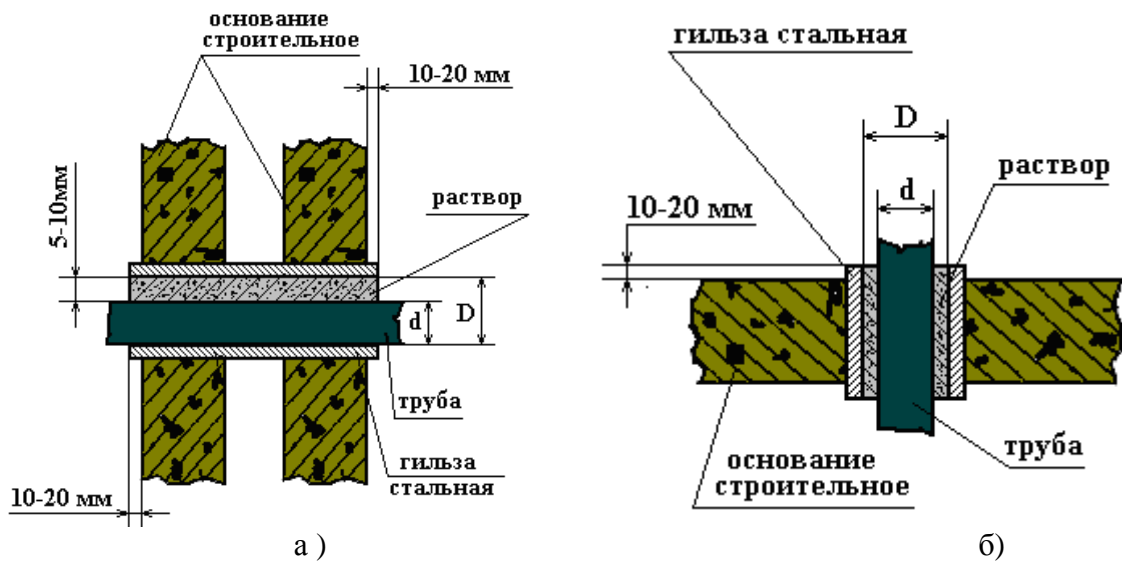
Переход стальной трубы: а) через температурно - осадочный шов; б) через горизонтальное строительное основание
